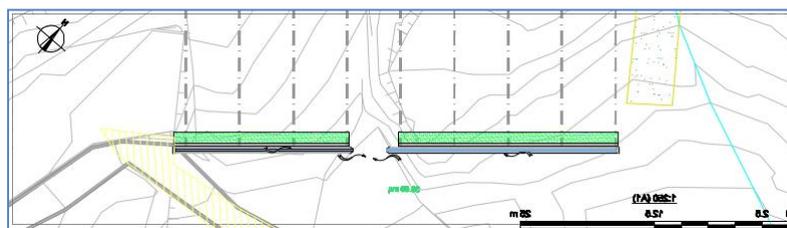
Inerbimento area lavorazione “dreni sub-orizzontali”
